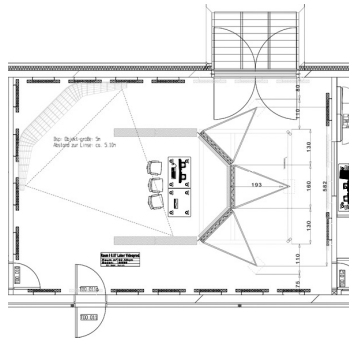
Grundriss MediaSynthesisLab mit trapezförmiger Leinwand
